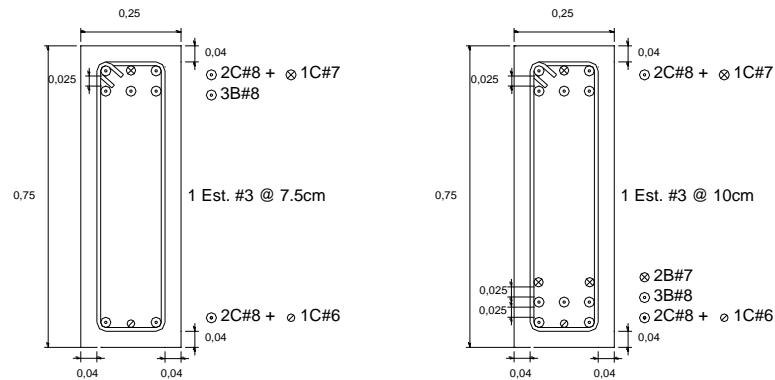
Ejemplo de sección transversal de viga de 25x75cm
